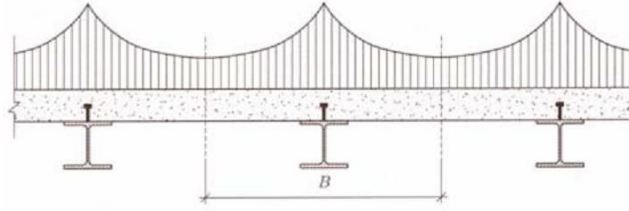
Distribuição de tensões longitudinais nos banzos de betão [118]
